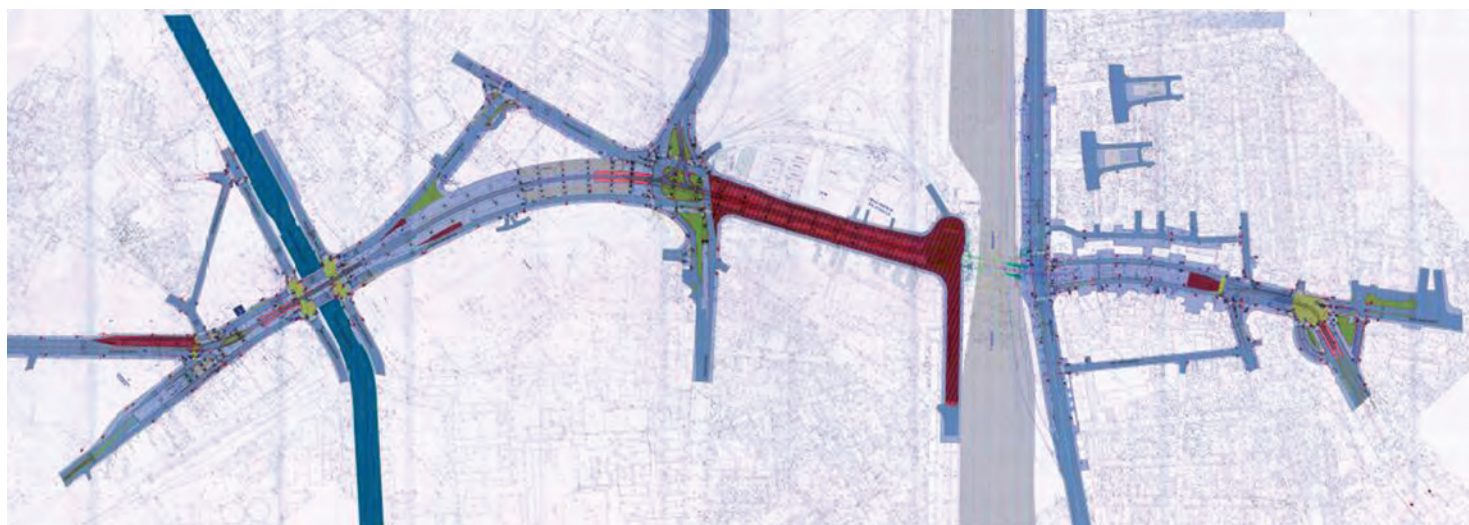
Plan de situație drumuri la sol, bretele și rampe de acces pe pasaj
